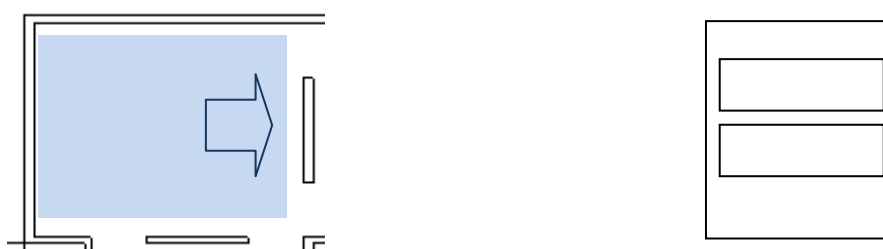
Módulo Contexto Urbano. Planta baixa e elevação esquemática da parede 04.
